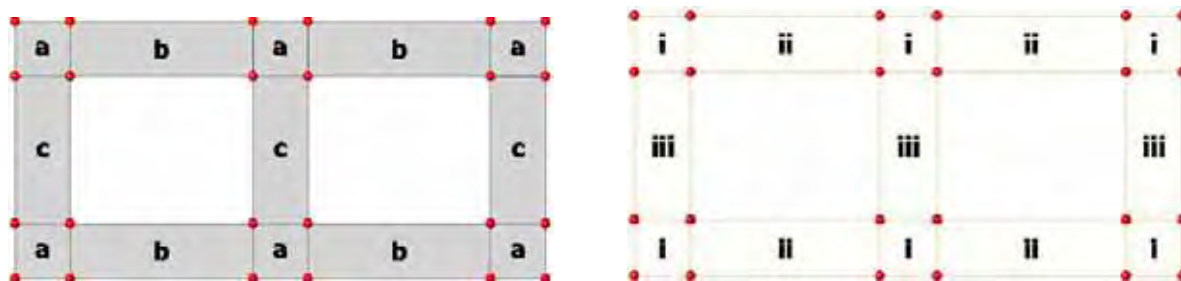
Configuração dos blocos e juntas de argamassa vistas em planta
